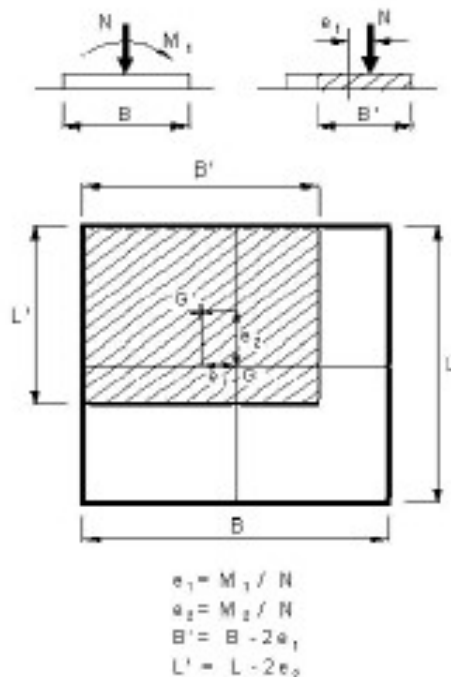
Fondazione efficace equivalente nel caso di fondazione rettangolare
